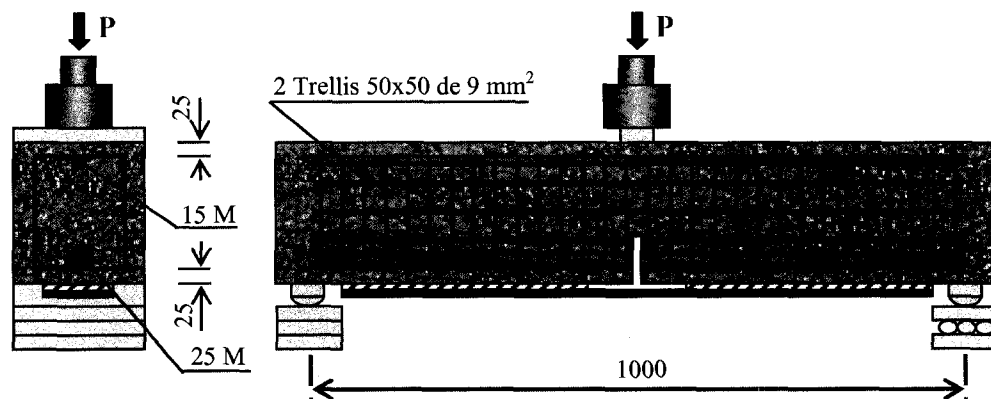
Poutrelles du Groupe D : renforcement avec treillis double
